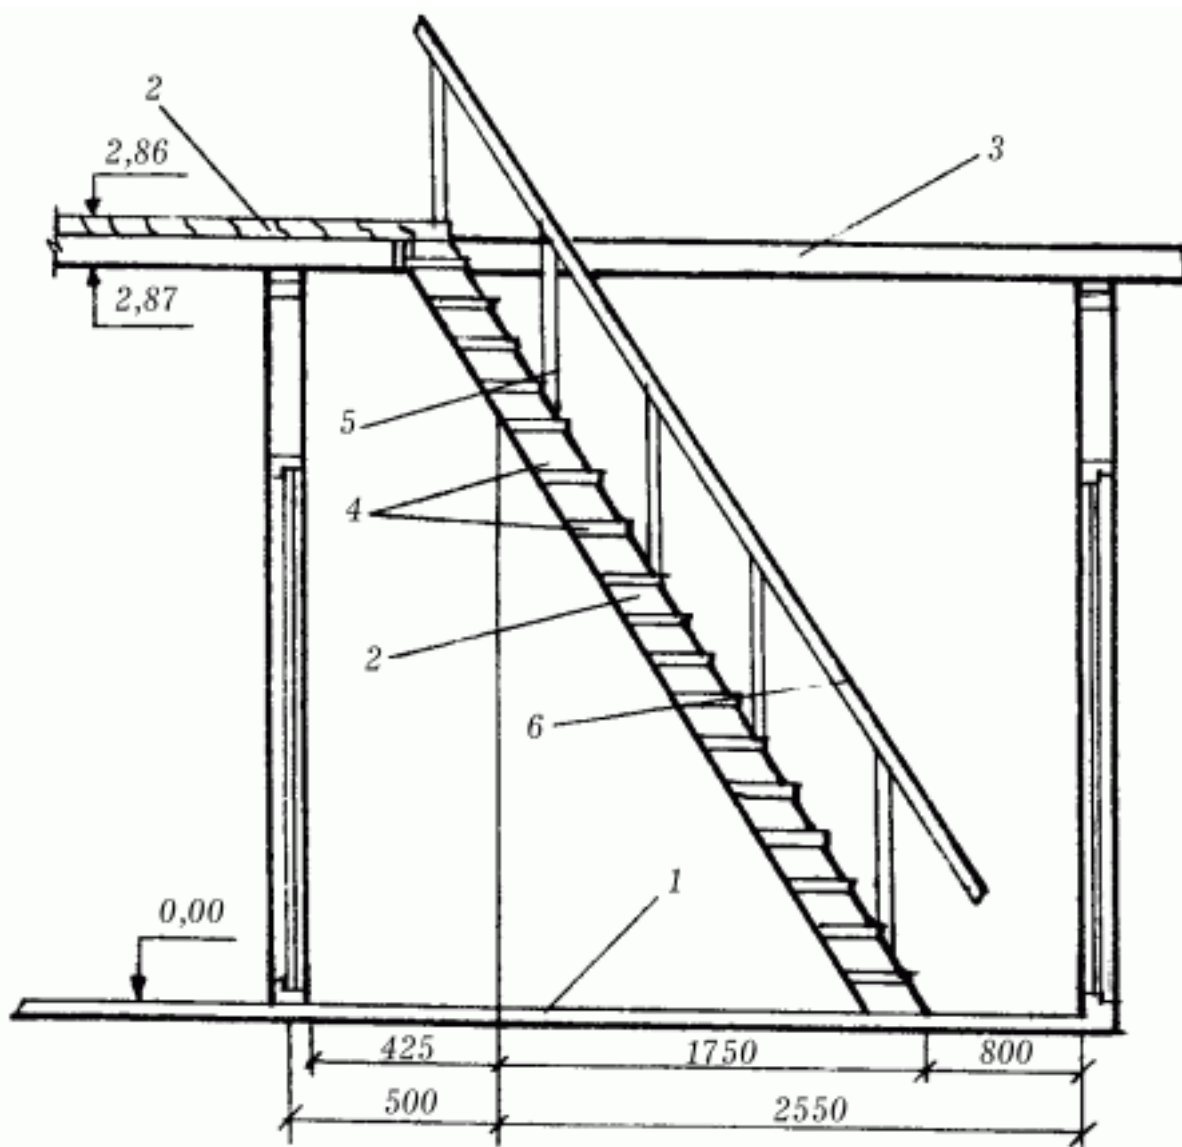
Конструкция деревянной внутренней межэтажной лестницы: 1 – доски пола; 2 – тетива лестницы; 3 – балка межэтажного перекрытия; 4 – ступень; 5 – стойка ограждения; 6 – перила лестницы.
